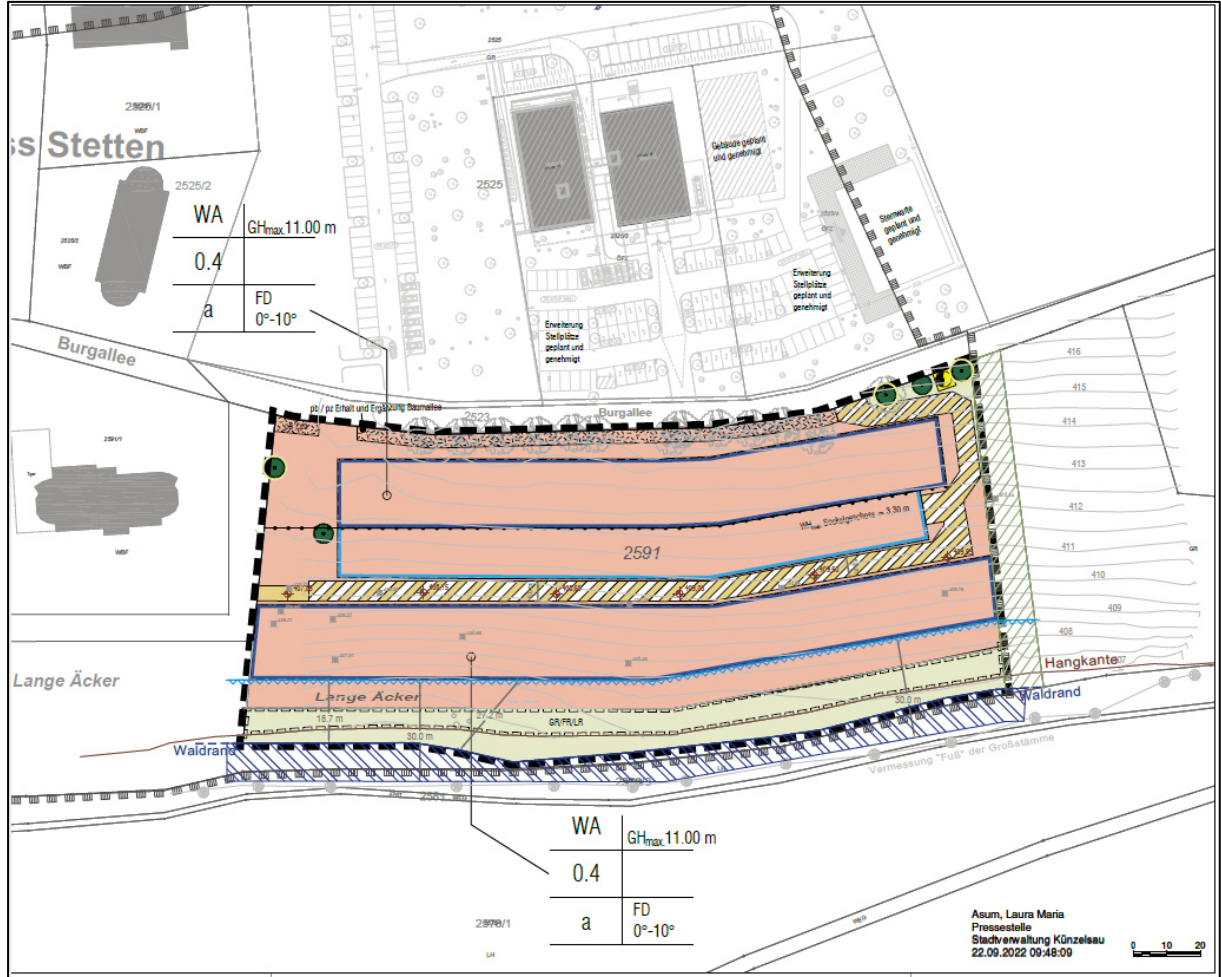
Entwurfsplan zum Geltungsbereich des Bebauungsplans „Erweiterung Wohnungsbau Schloss Stetten“, Stadt Künzelsau (schwarz gestrichelte Linie).
